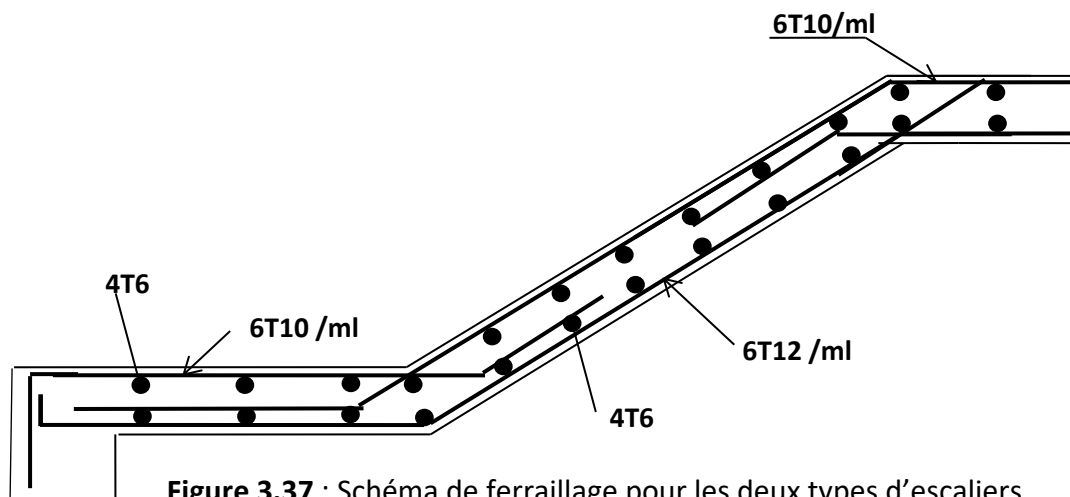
Schéma de ferrailage pour les deux types d'escaliers (var 2).
